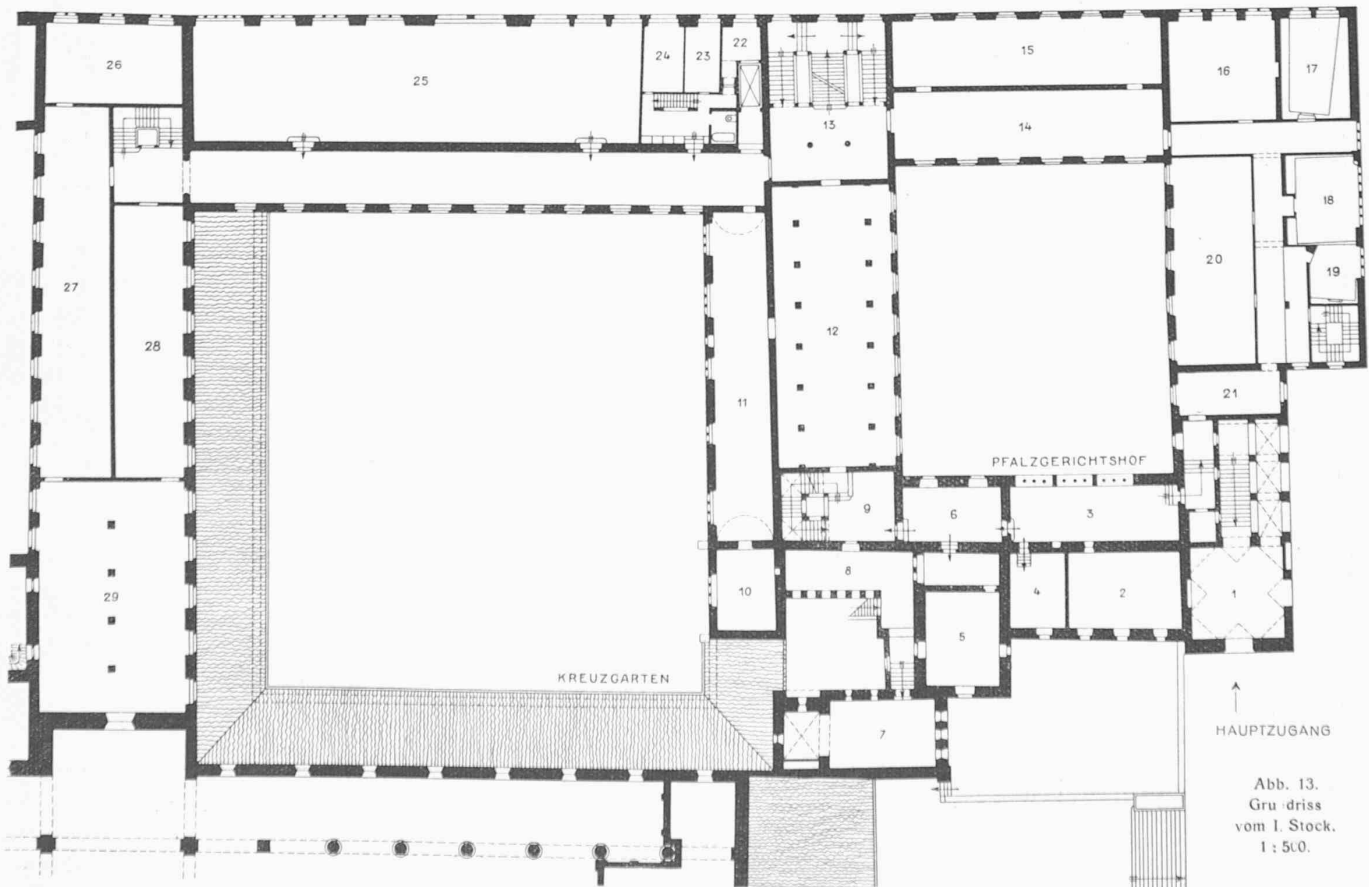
Grundriss vom I. Stock. 1:500.
